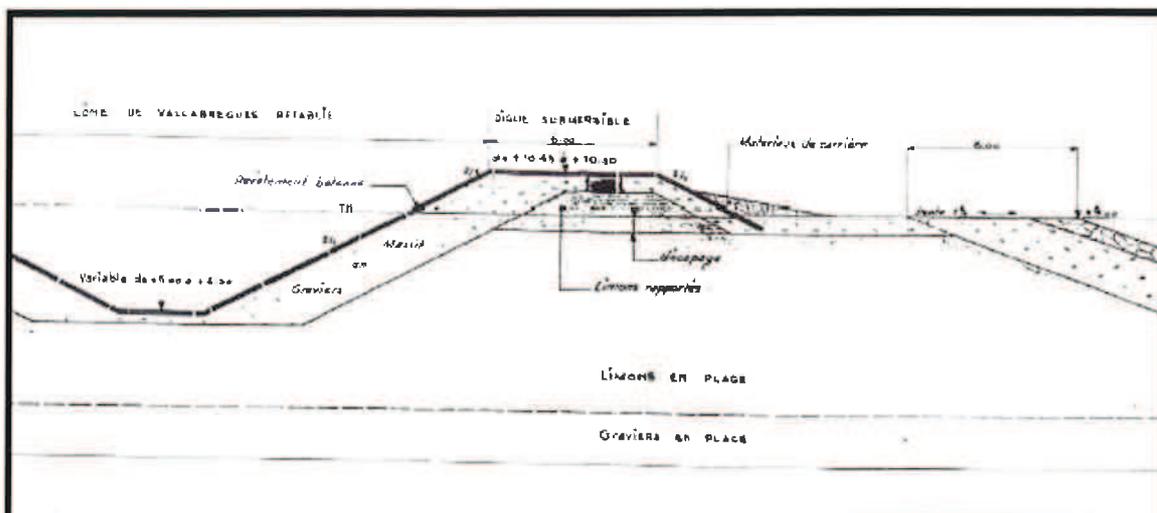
Coupe type de l'ouvrage existant – déversoir de Boulbon
